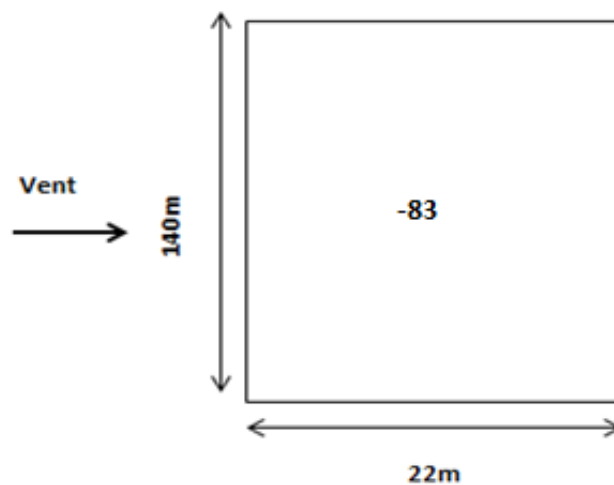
Pressions sur la toiture versant 2 et 3 directions du vent (V2,V4) [daN/m²].
